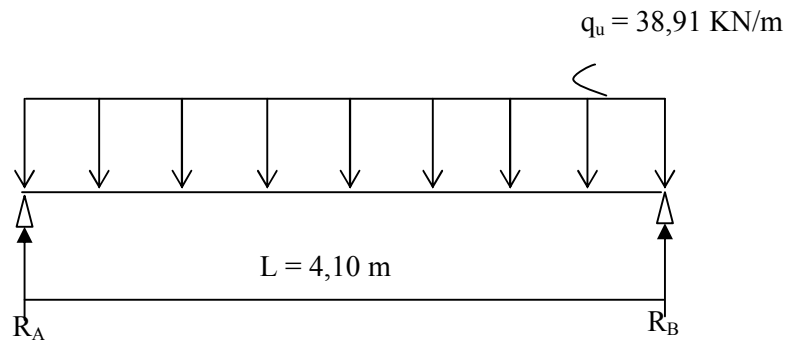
Schéma statique de la poutre palière (ELU)
